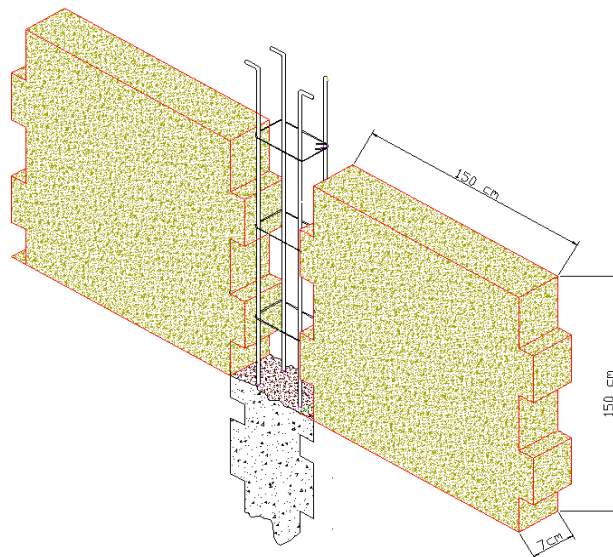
Panel prefabricado simple para unión con mortero de cemento (Modelo 2)
